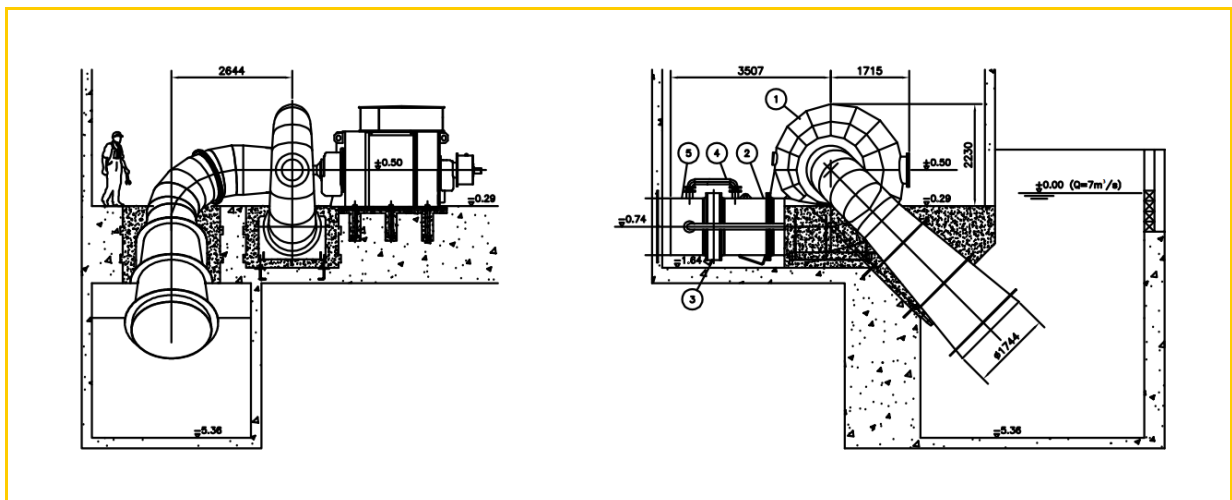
Aproximación dimensional fabricante Turbina -2.
